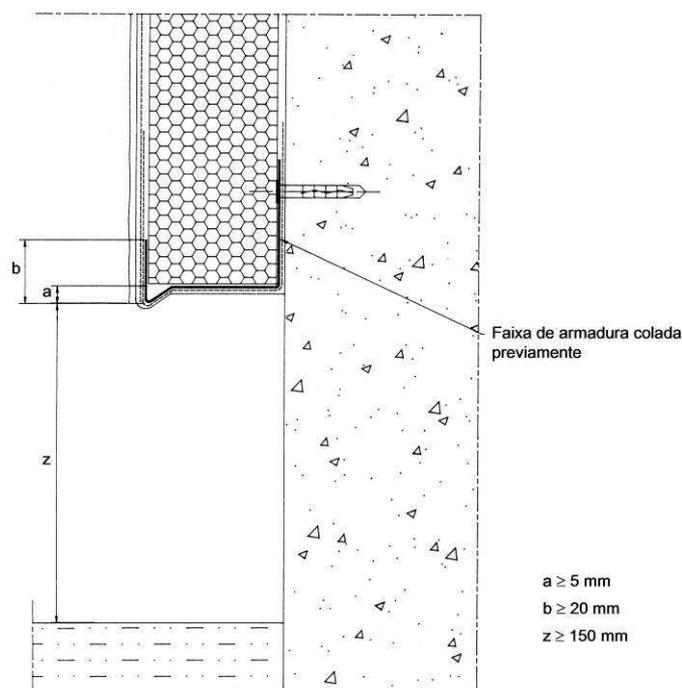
Limite inferior do sistema (corte vertical) [3]
